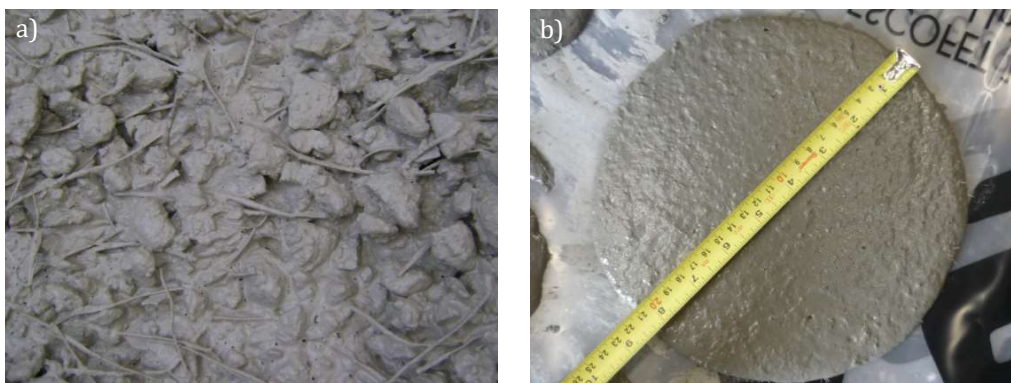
Hormigón con fibras plásticas (a) y hormigón autocompactante de alta resistencia (b).
